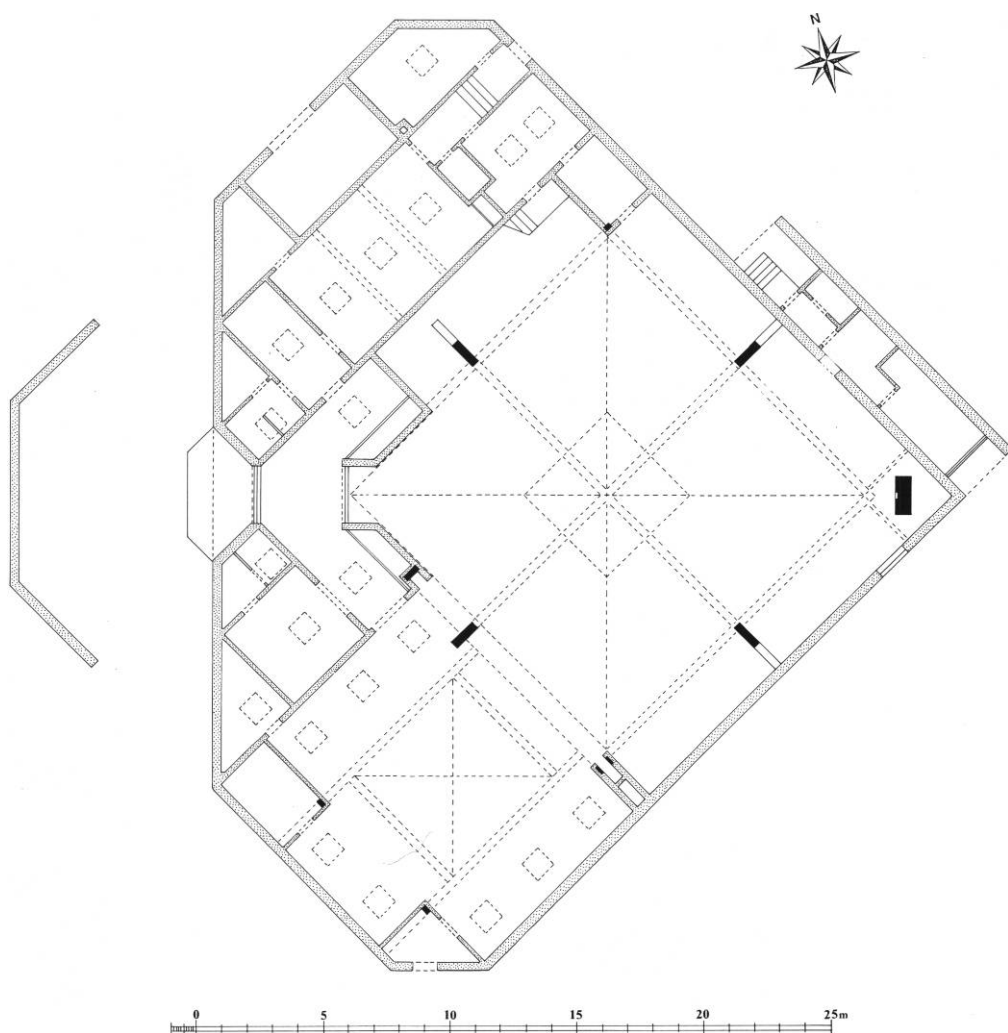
Plan 1:300. Tegnet af MN 1998, på grundlag af tegning i Ebbe Lehn Petersens arkiv. - *Plan.
